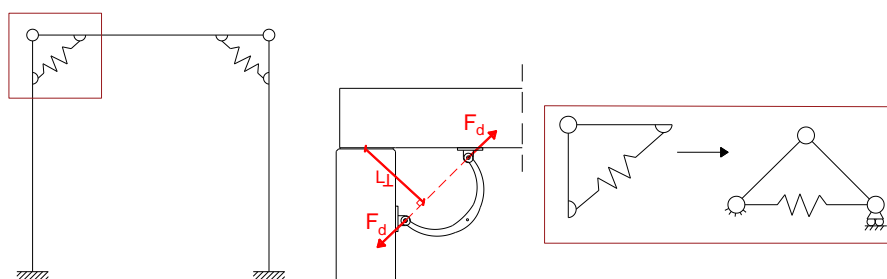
Schema statico con collegamento trave-pilastro schematizzato con molla assiale.
